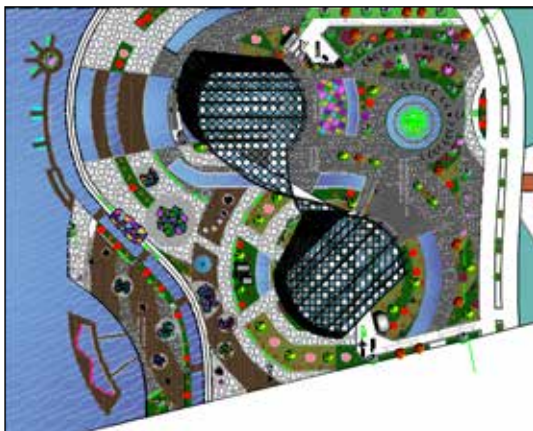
Planta Conjunto. Ferrer Rivero, Angélica María.(2016).
